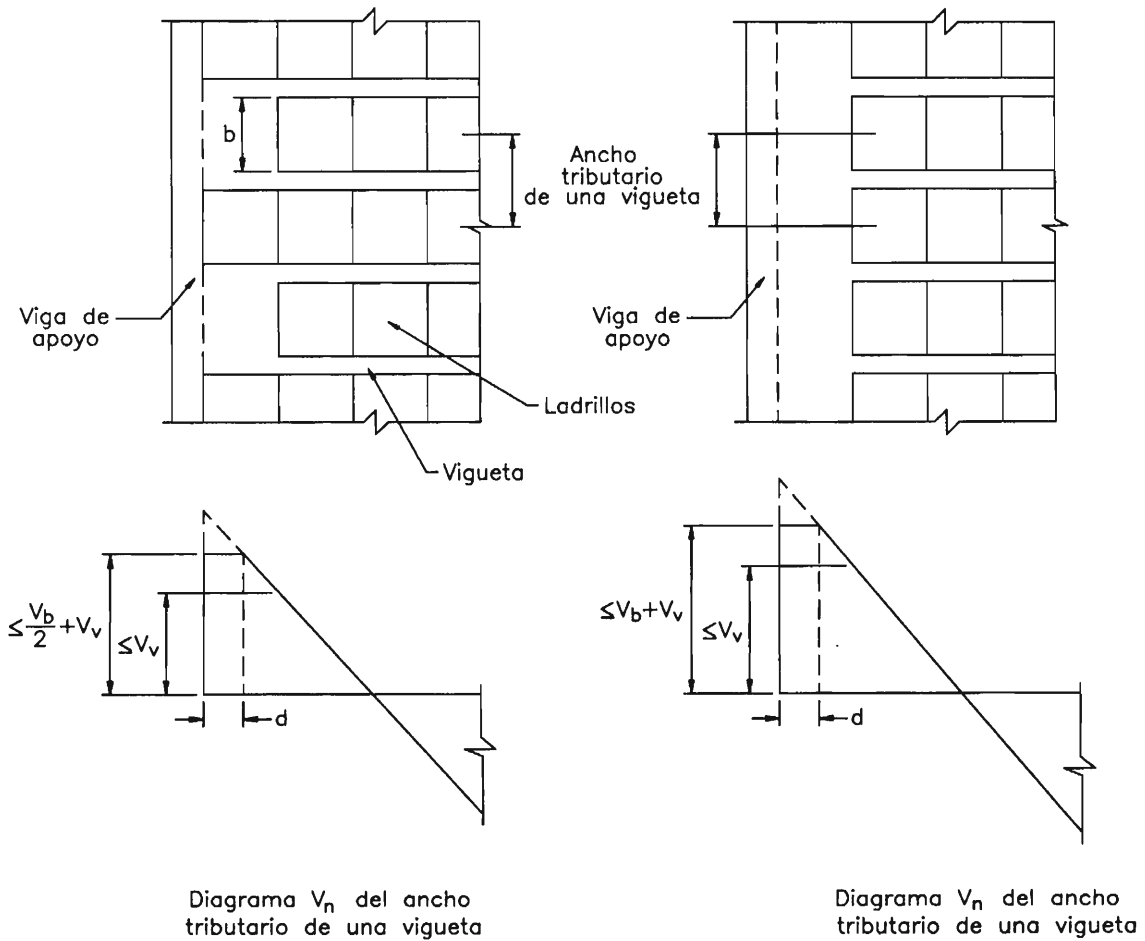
Retirado de ladrillos en los apoyos de losas aligeradas
